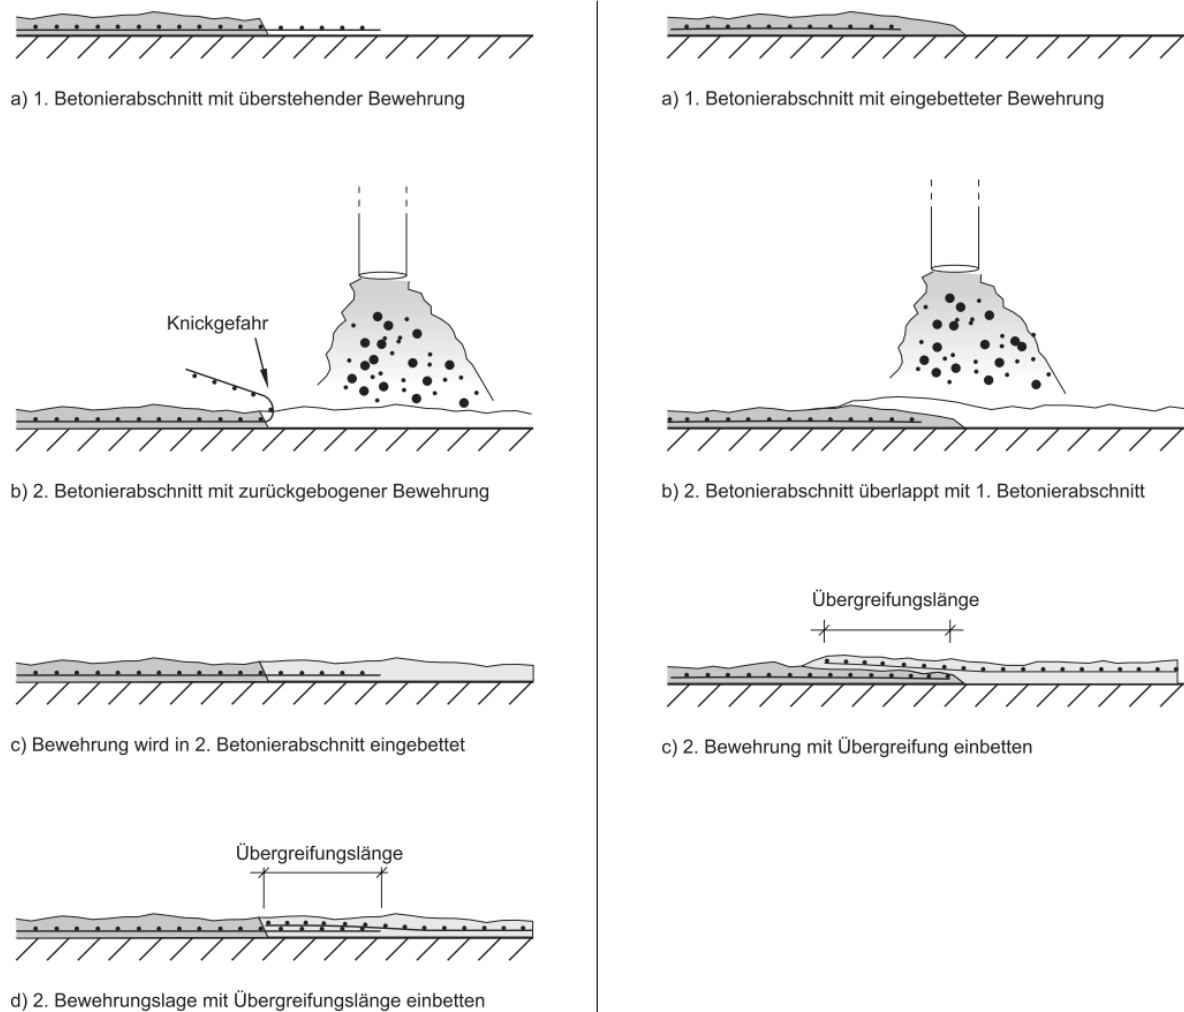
Ausführungsvarianten von Arbeitsfugen: links mit Anschlussbewehrung, rechts als indirekter Anschluss
